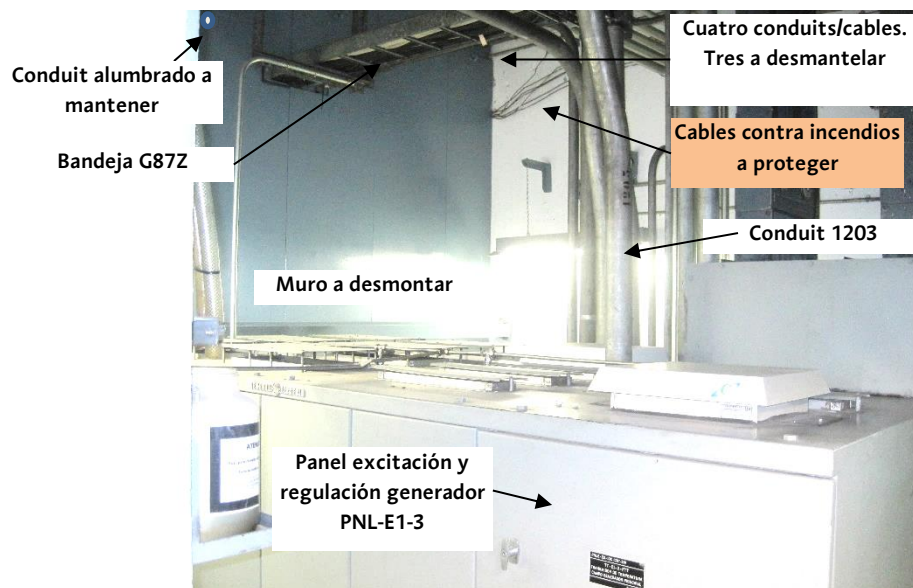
Detalle de disposición de bandeja eléctrica G87Z, conduits y cables contra incendios a proteger.
